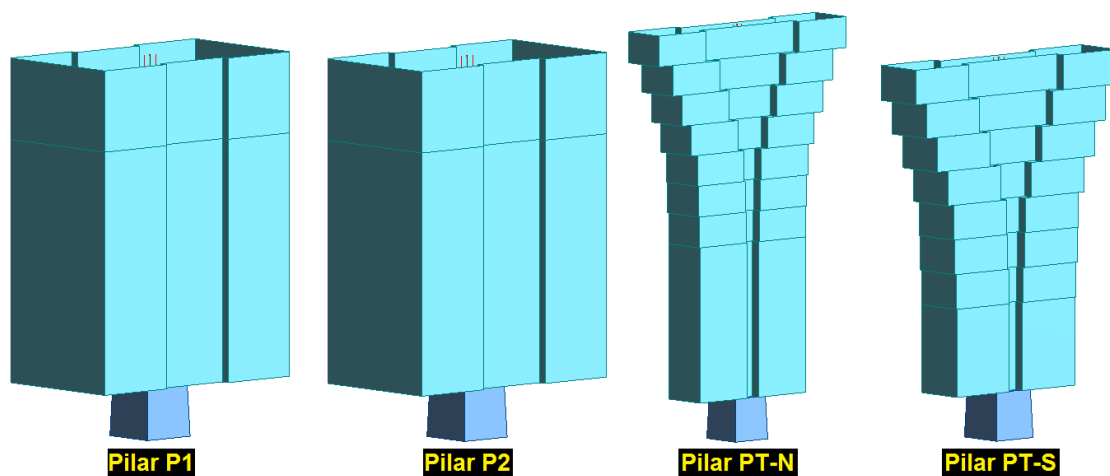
Modelação dos pilares da ponte sobre o rio Sorraia.
